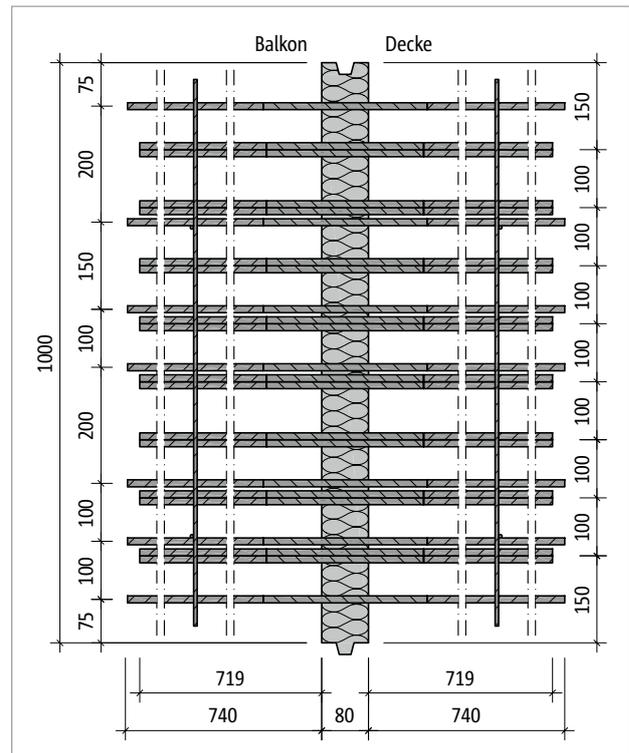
Schöck Isokorb® T Typ D-MM3-VV5: Grundriss
